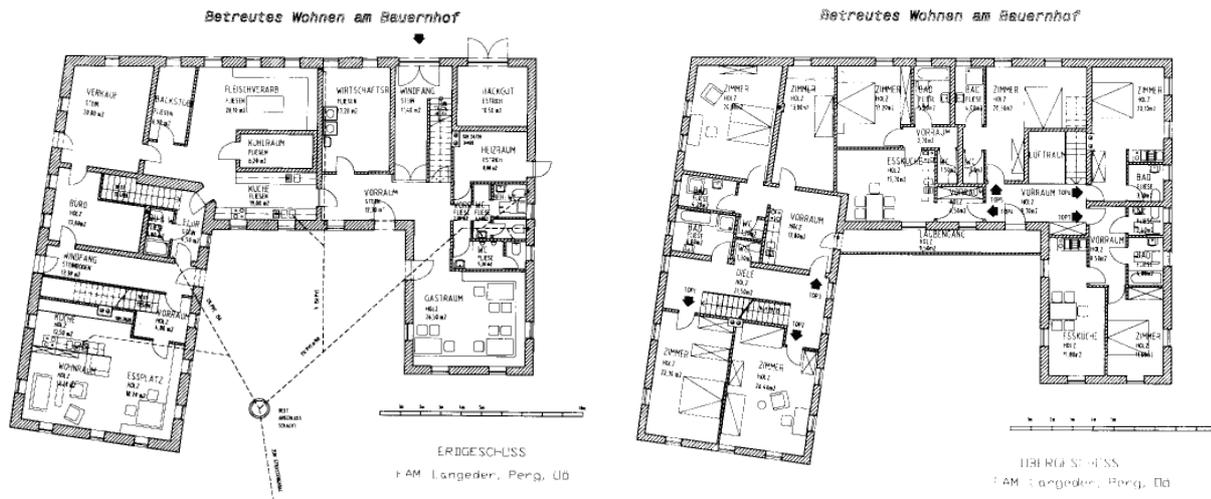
/29: Grundrissplan Dreiseithof: EG links und OG rechts. Im OG befinden sich 2 Betreute Wohnungen
